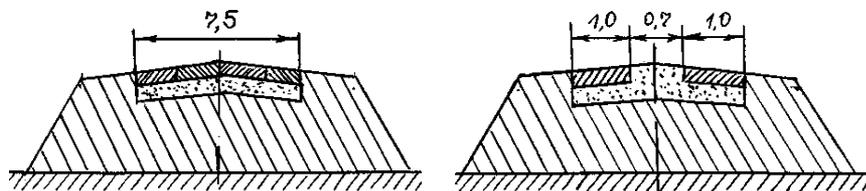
Поперечные профили сплошного (а) и колейного (б) дорожного покрытия из бетонных плит
